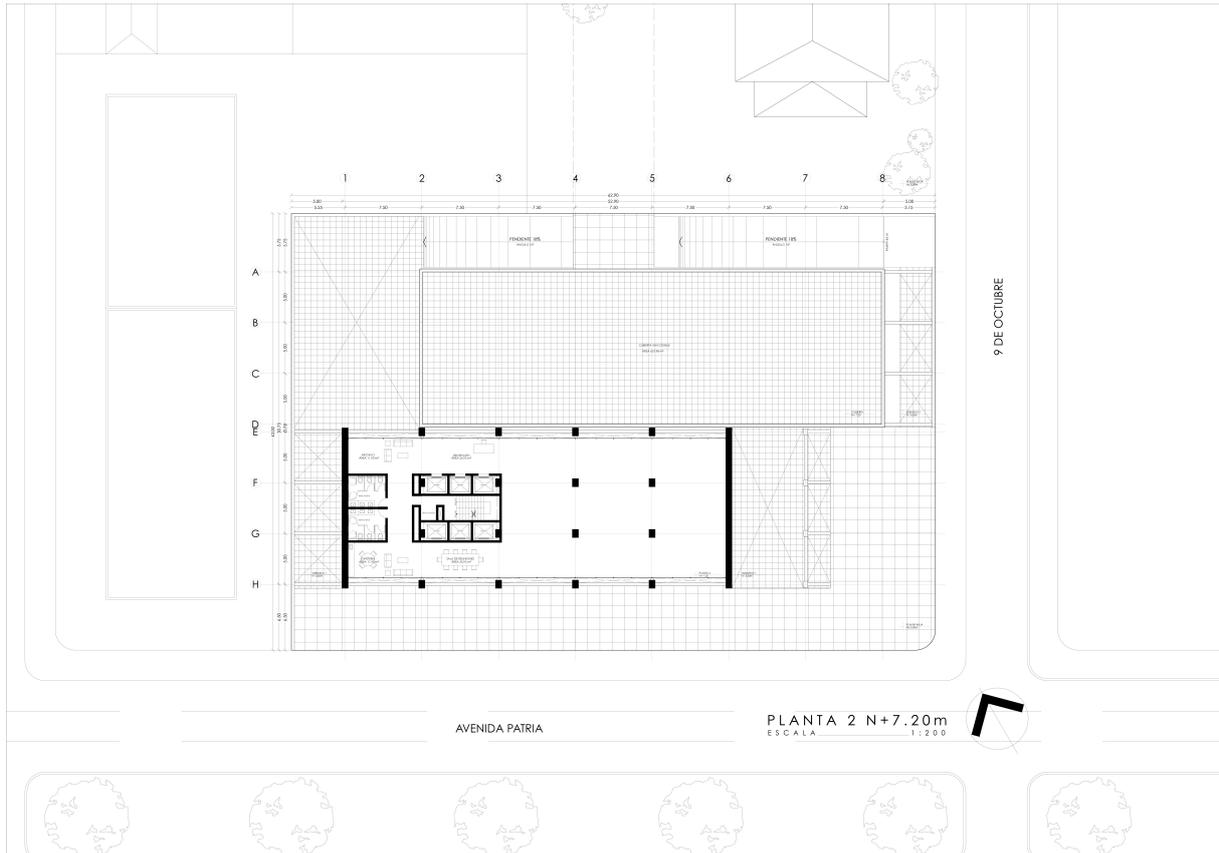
Plantas 2 (N+7.20m). Elaboración Propia
